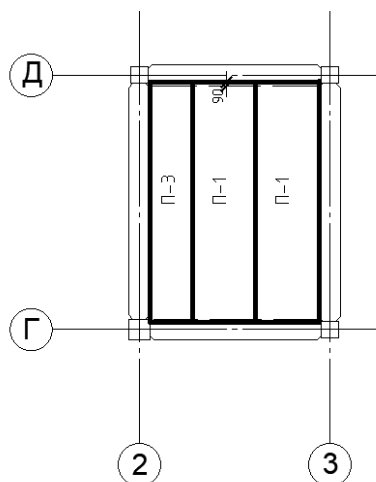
Схема сборного железобетонного перекрытия
